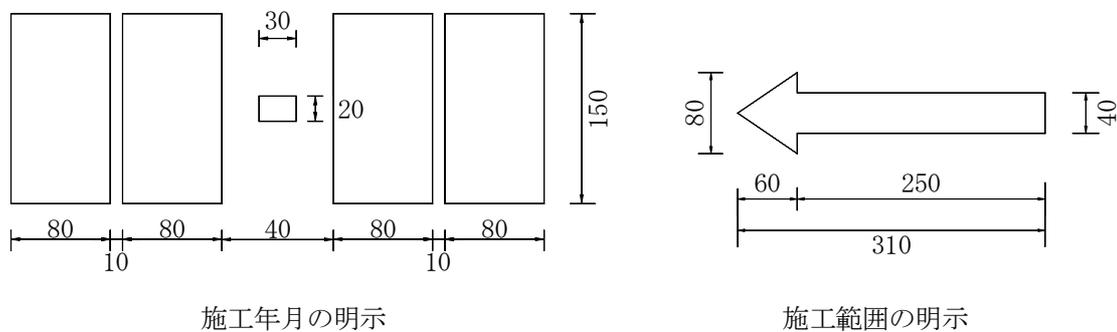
施工年月（和暦）・施工範囲の明示（単位mm）
